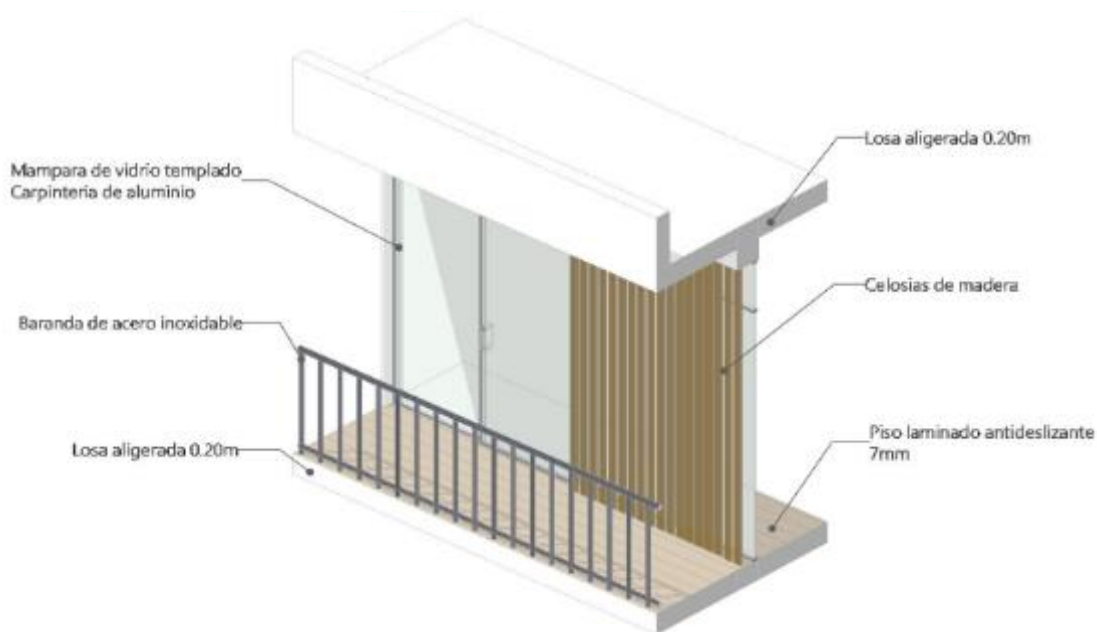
Celosía fija en Fachadas de residencia, gimnasio e ingreso
